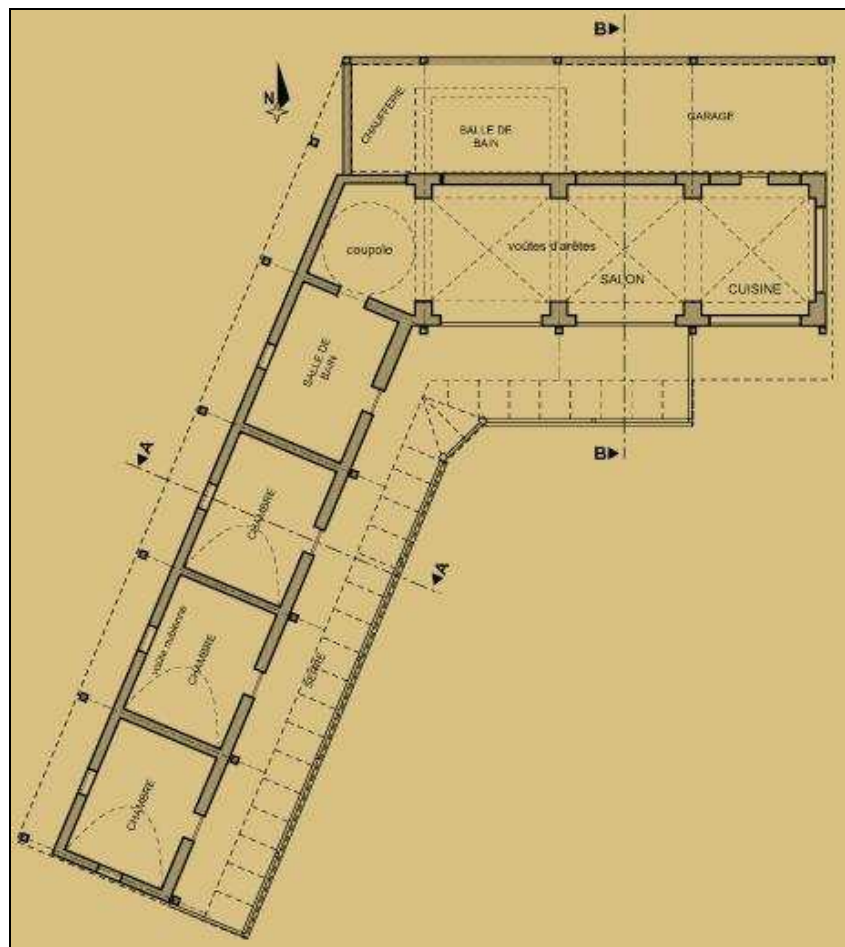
Moulin de la Resse, plan rez-de-chaussée.
